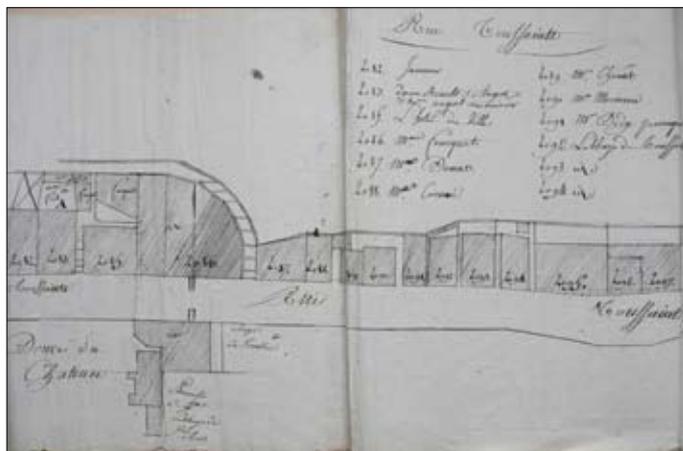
L'escalier de la porte des Petits Murs en arrière de la porte Toussaint. Plan parcellaire vers 1770. Arch. dép. Maine-et-Loire, E 4362. Phot. F. Comte.
